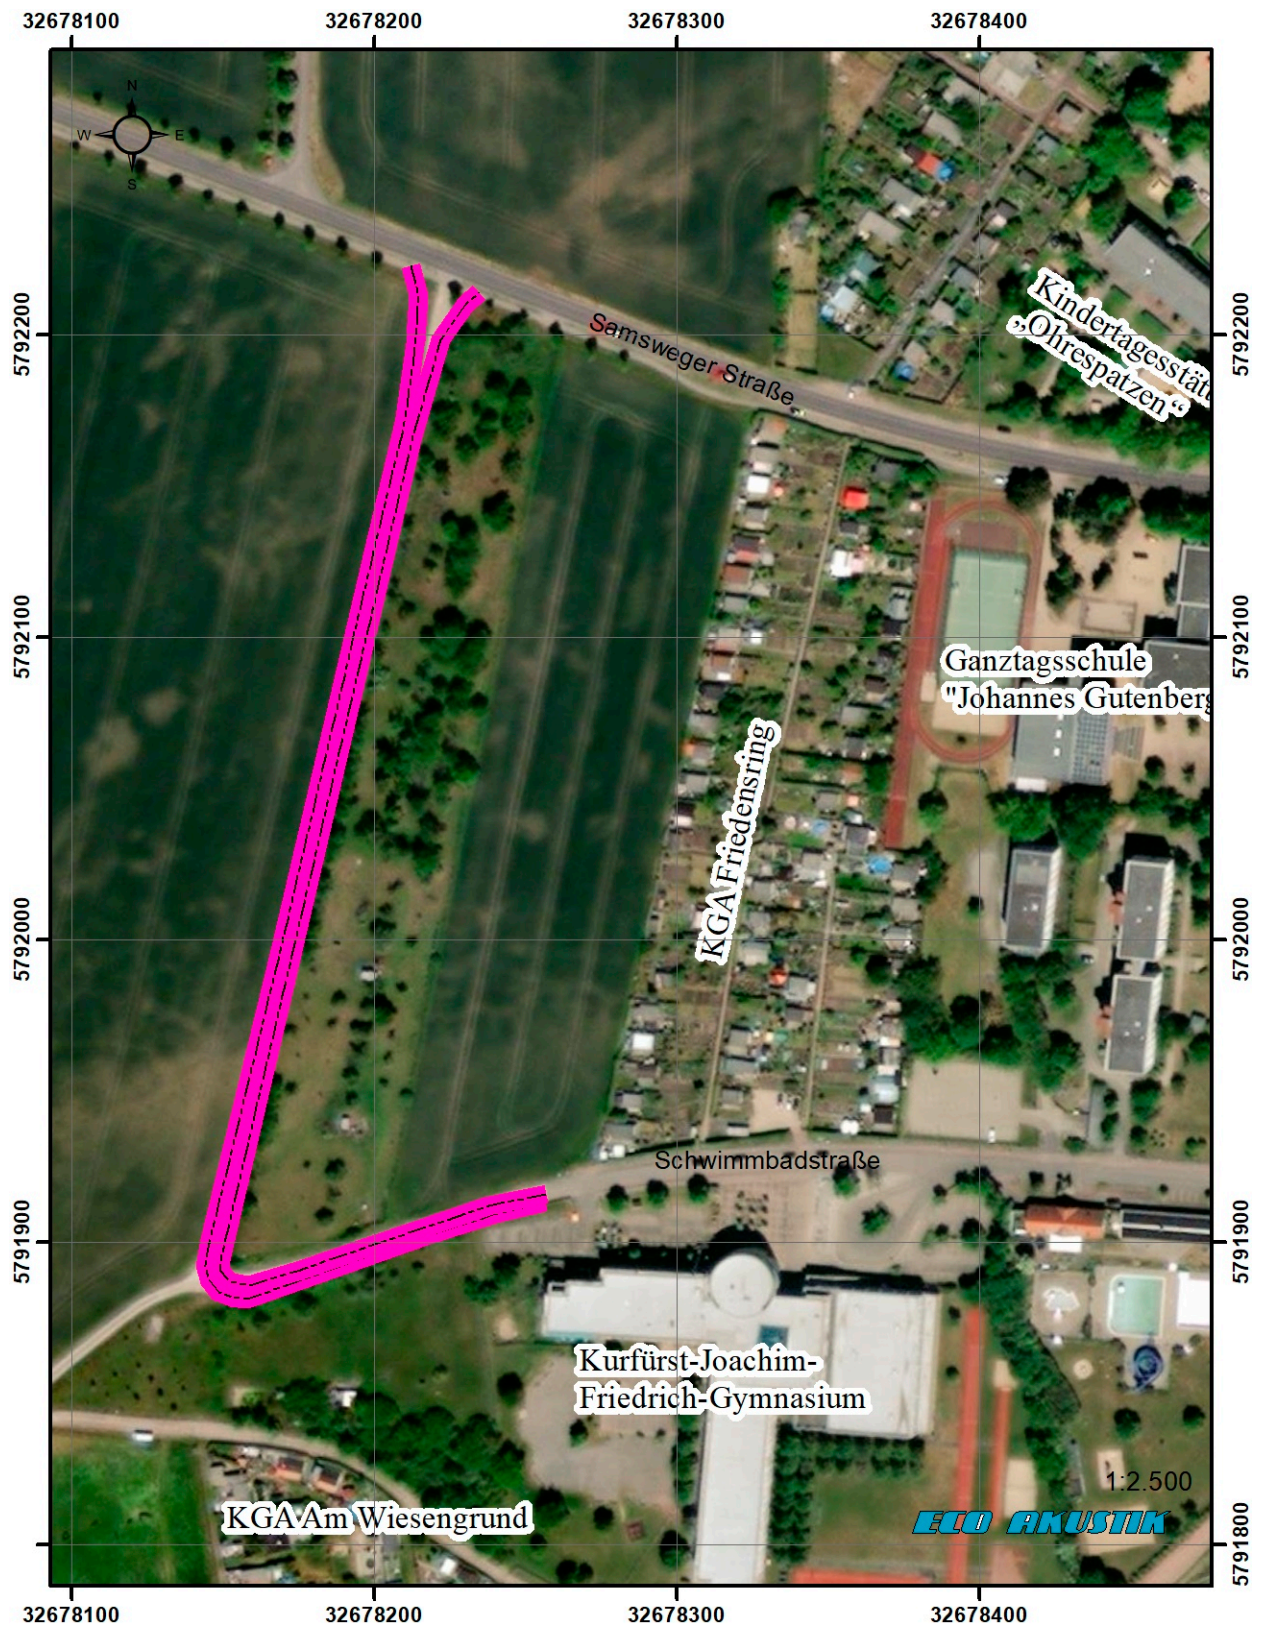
Übersichtslageplan des geplanten Straßenneubaus
